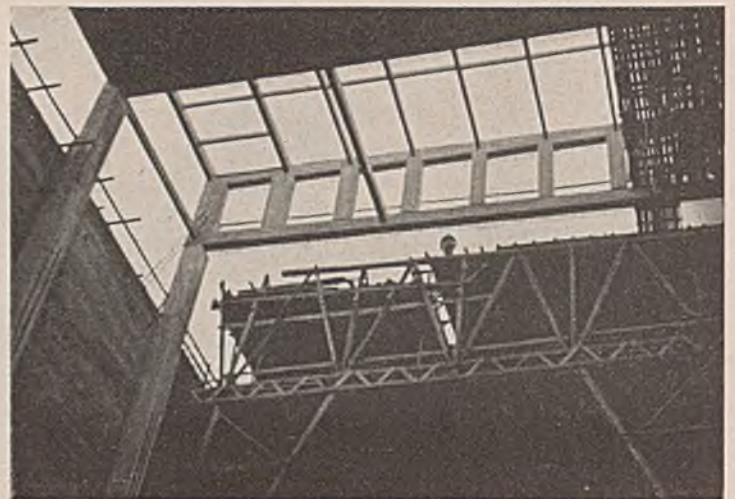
Gerüst des Maschinenhauses nach dem Ausfahren, das noch offene Dach wird mit Blindsdiele geschlossen.
